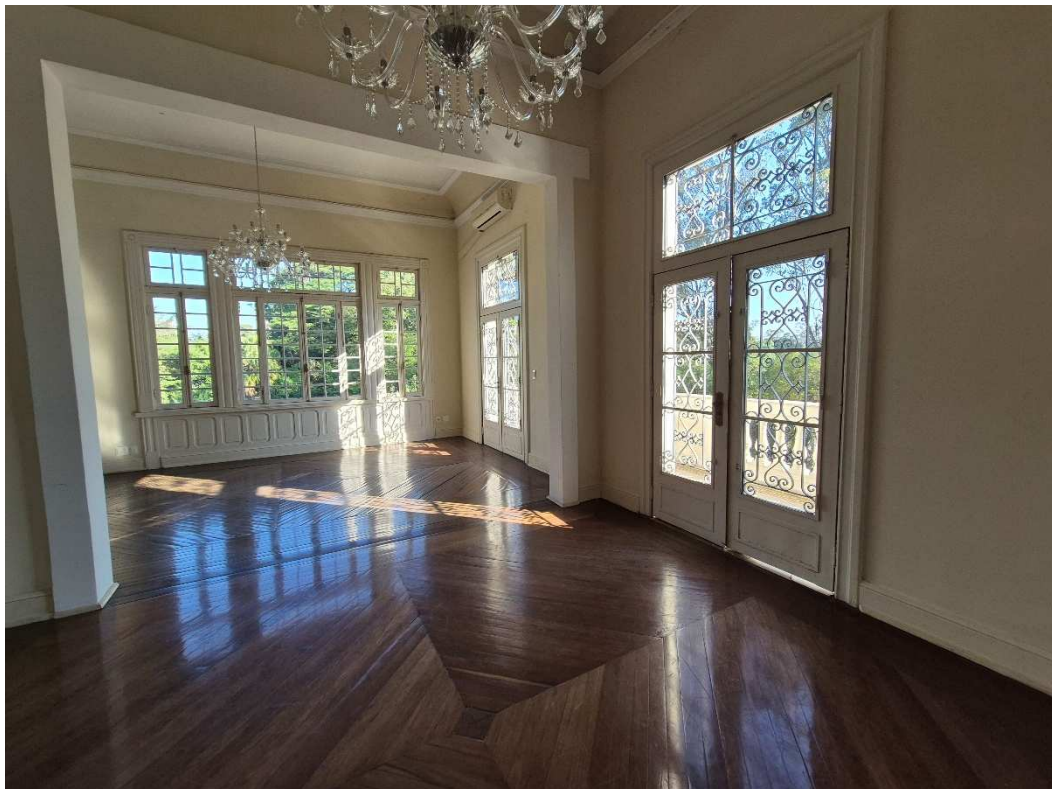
Aspecto interno da edificação principal (Pavimento Superior).
